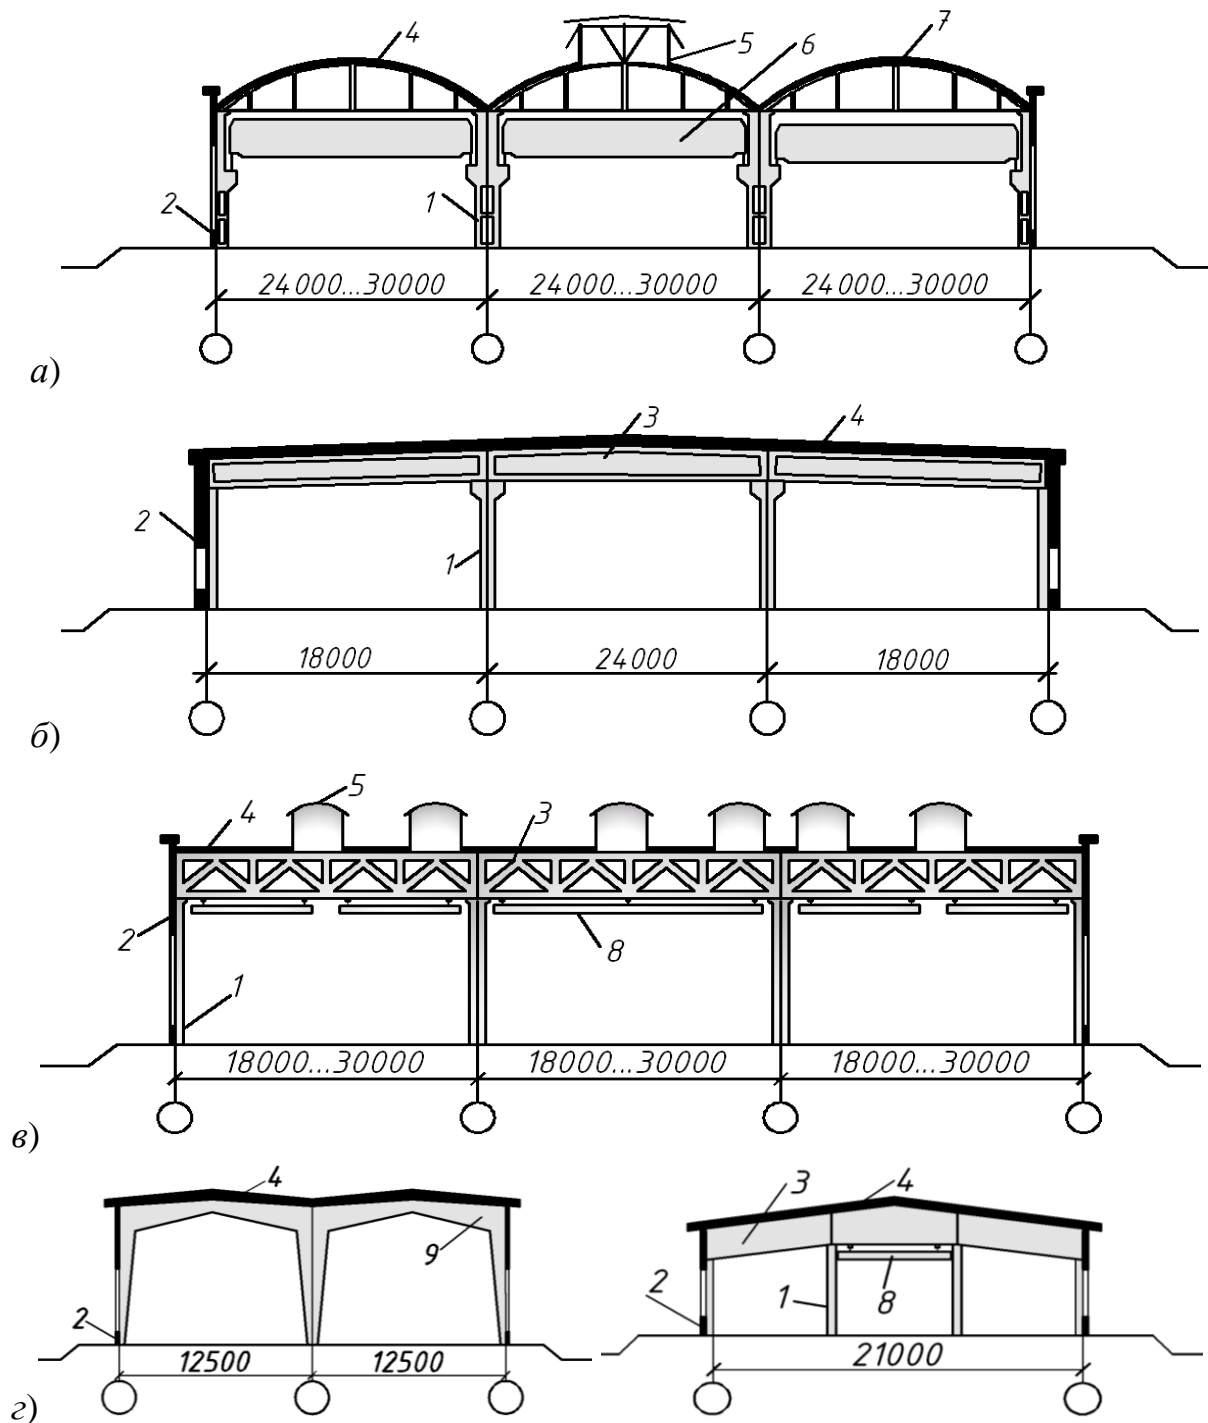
Схеми поперечних рам одноповерхових виробничих каркасних будівель із залізобетонних конструкцій:
